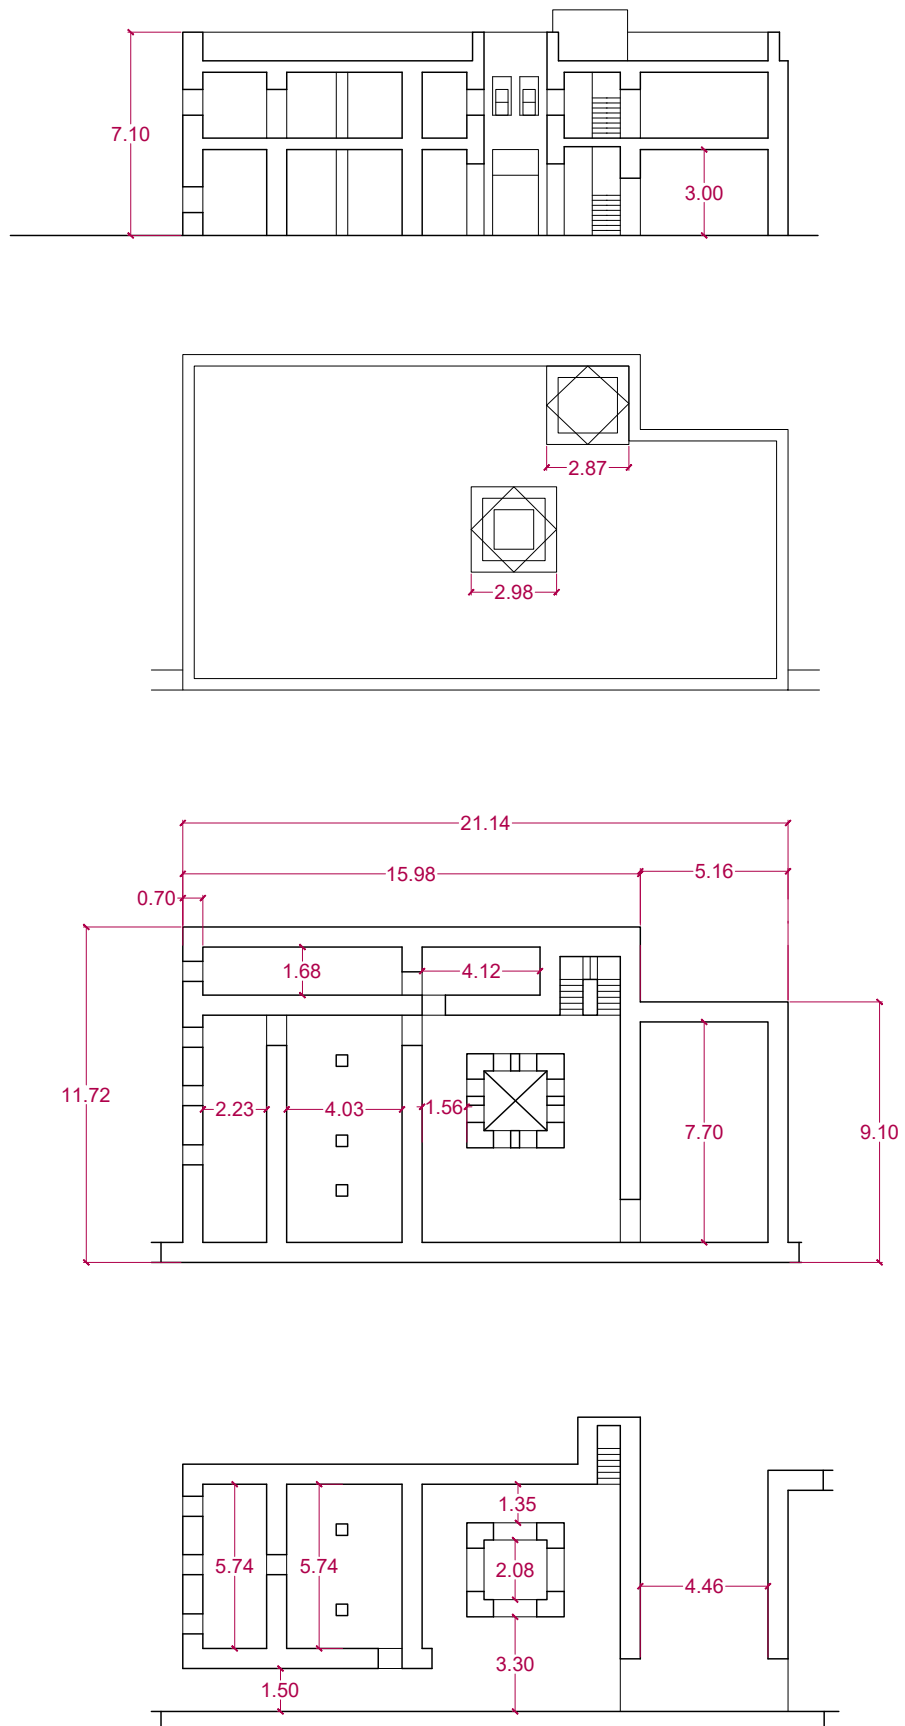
Planos Tipología 4 de vivienda. Elaboración propia con AutoCAD
